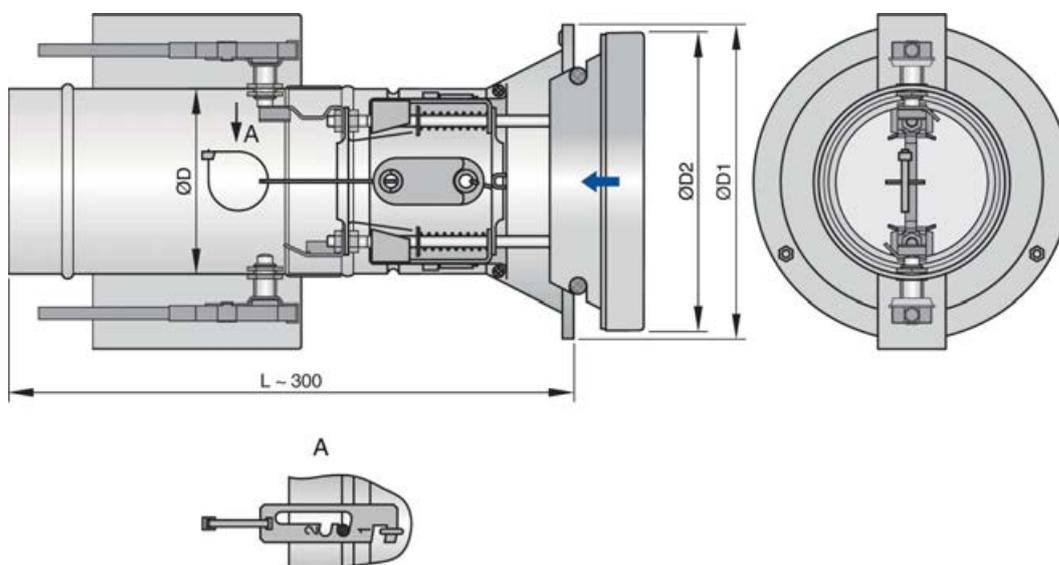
FV-EU avec fusible thermique, interrupteur fin de course et pièce d'extension et
